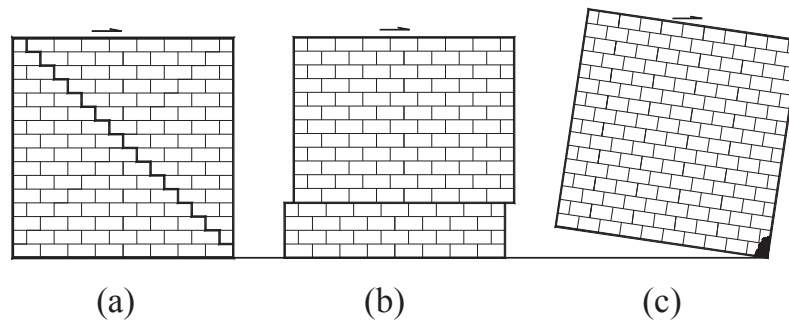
Modes de rupture en plan d'un mur de maçonnerie non armée (a) tension diagonale (b) glissement des joints (c) balancement et écrasement en compression [Elgawady, 2004]
